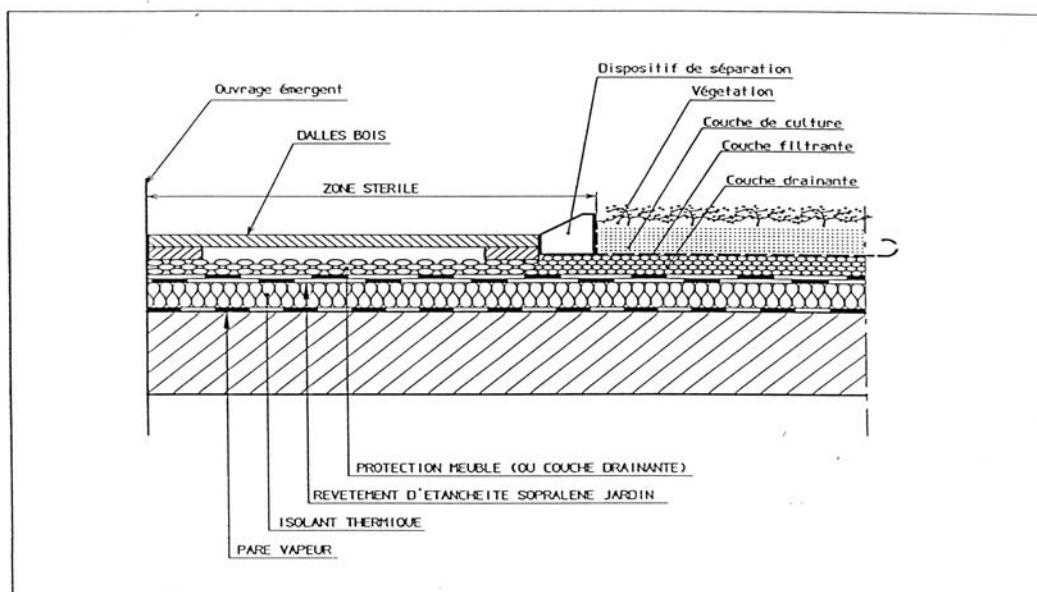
Exemple de dispositif de séparation par bordure préfabriquée en béton ou en pierre avec zone stérile en dalles bois (DALDECOR ou PRESTIDALLE)
